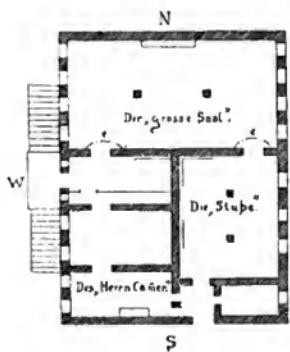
Grundriss des ersten Stockes zur Zeit des Vertrags von 1558.
